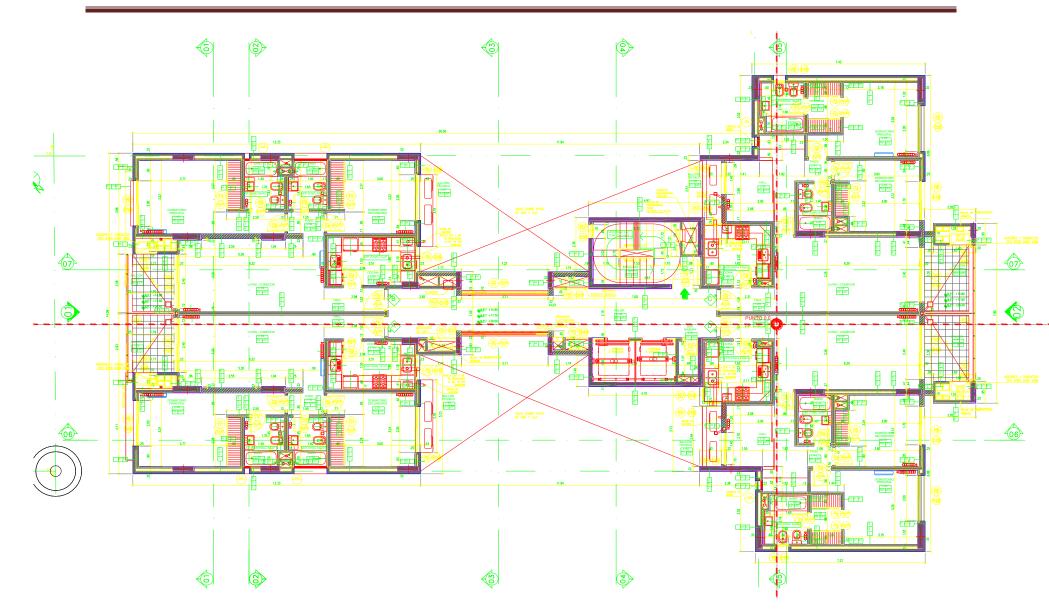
Planta del Segundo Piso al Decimo Piso.
